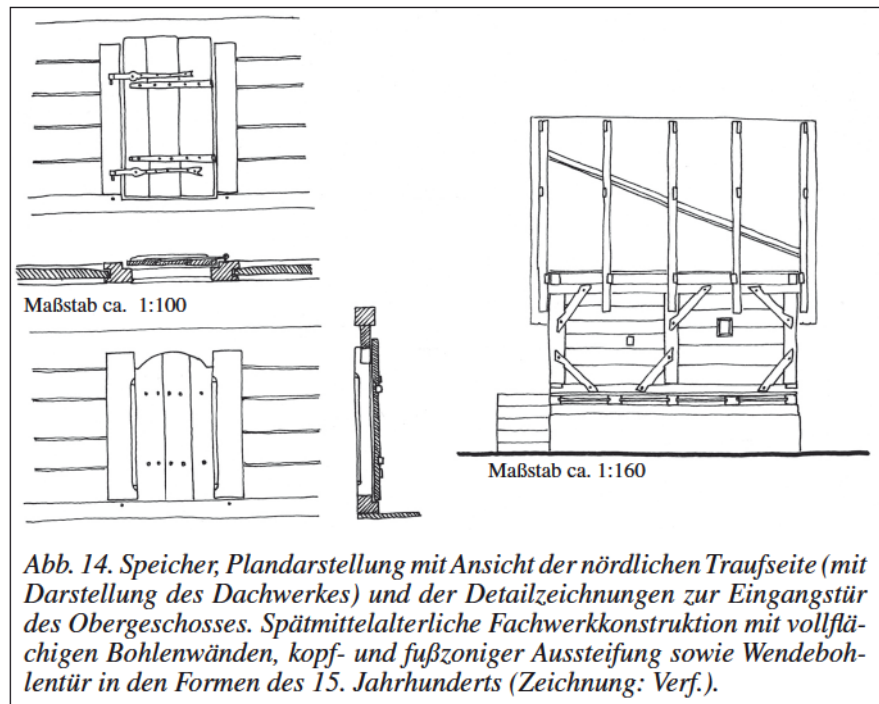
Speicher, Plandarstellung mit Ansicht der nördlichen Traufseite (mit Darstellung des Dachwerkes) und der Detailzeichnungen zur Eingangstür des Obergeschosses. Spätmittelalterliche Fachwerkkonstruktion mit vollflächigen Bohlenwänden, kopf- und fußzoniger Aussteifung sowie Wendebohlentür in den Formen des 15. Jahrhunderts (Zeichnung: Verf.).
